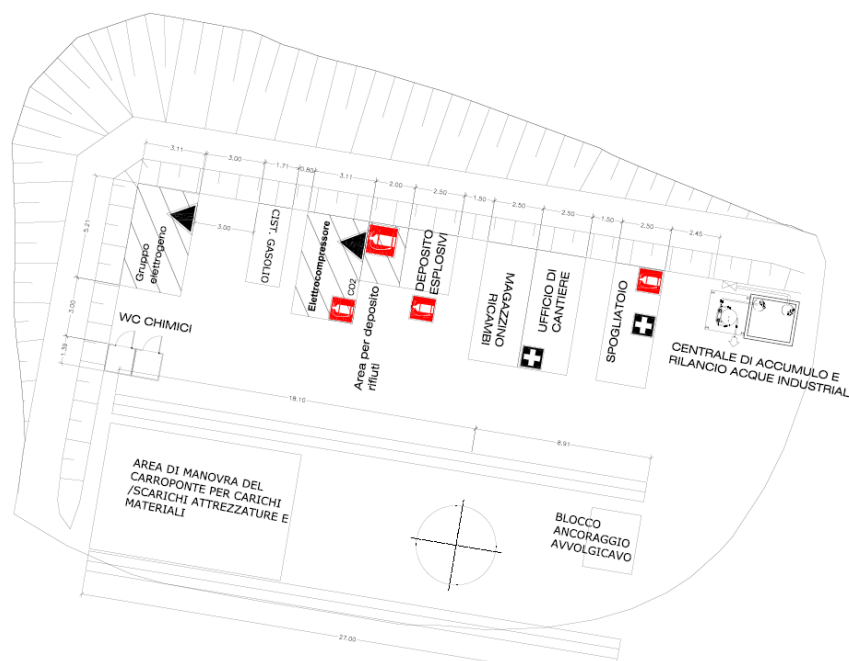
Cantiere pozzo: fase 2 – alesatura pozzo con scavo dall'alto
